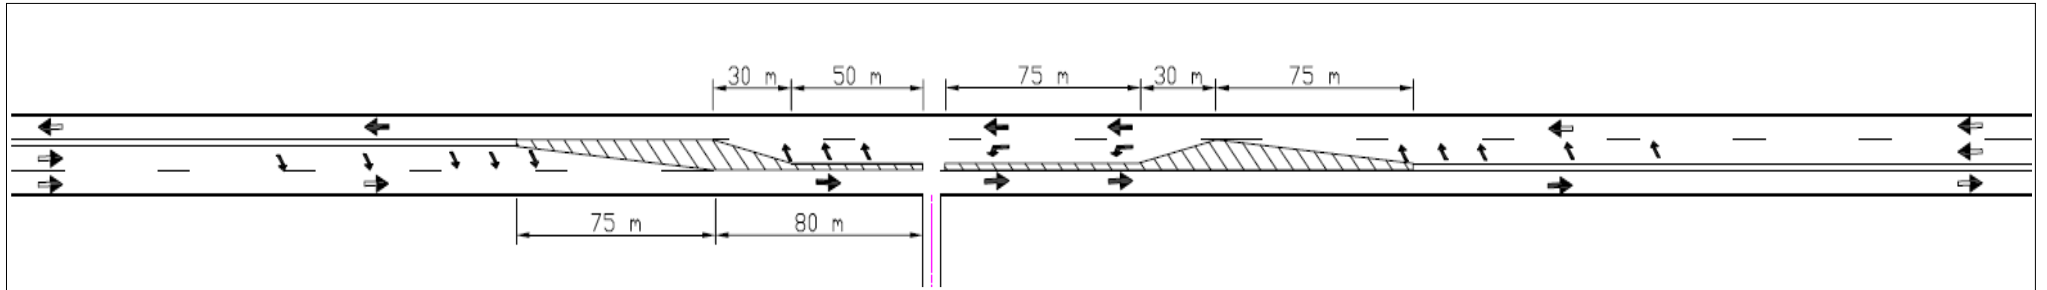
(intersecție cu zonă de alternanță de la 2 benzi la 1 bandă pe sens)
